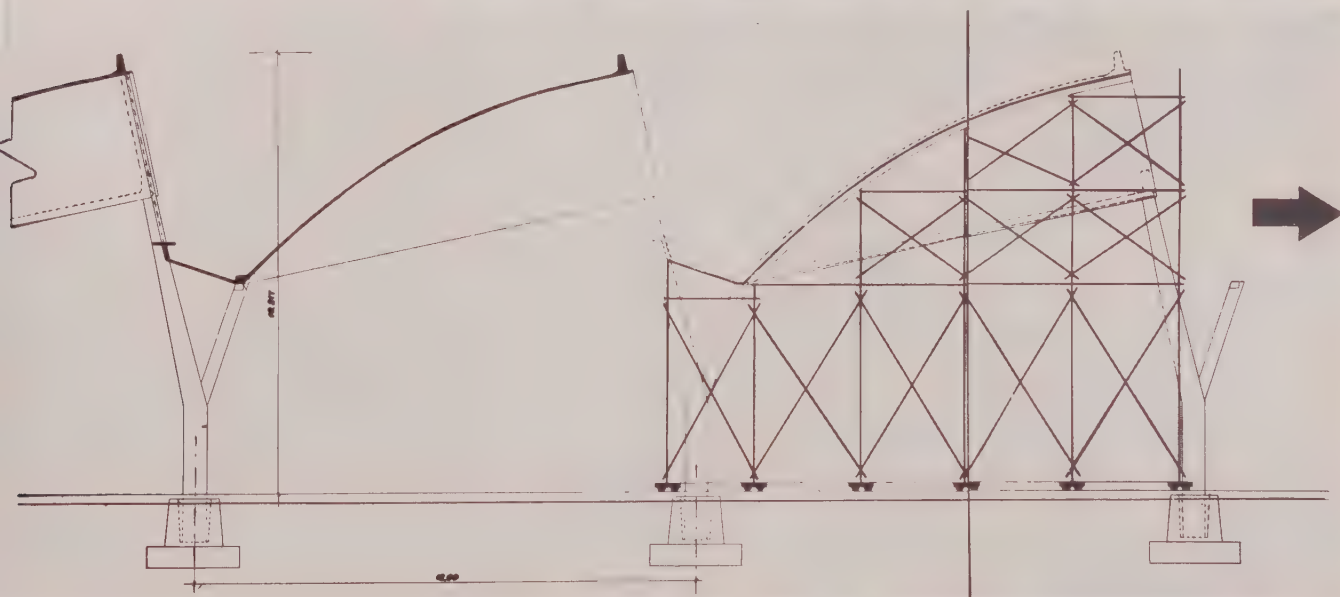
Halle der Spinnerei in Krosno, Fassade
